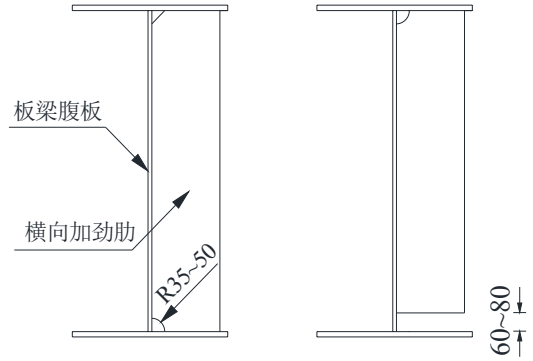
焊接横向加劲肋构造示意图 (单位: mm)
